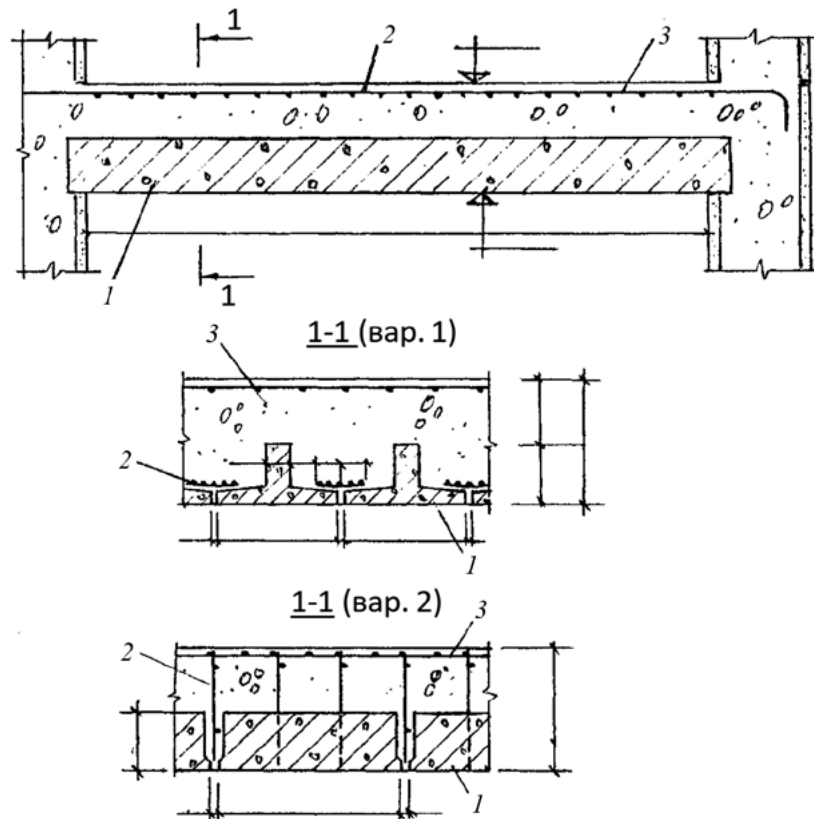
Примеры решений перекрытий в сборно-молитных конструкциях:
